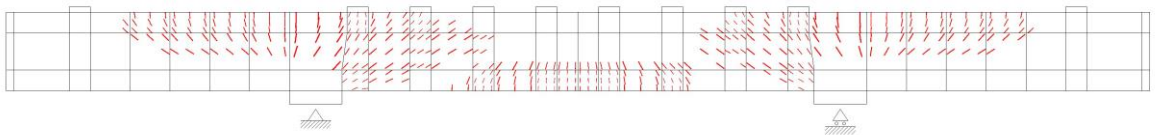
破壊時の変形及びひび割れ状態 (Case No. 16)
